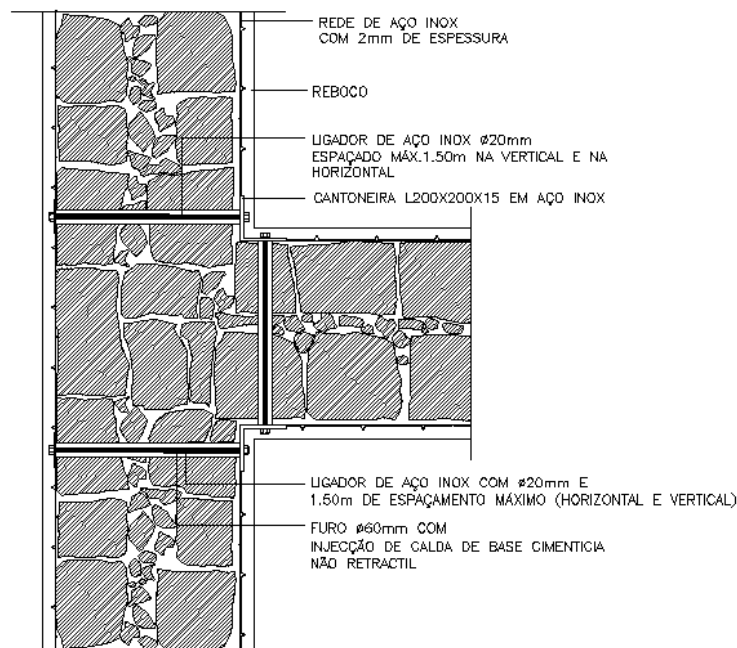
Corte horizontal do pormenor de reforço das paredes com estrutura metálica, quando se encontram três panos de parede [31].
